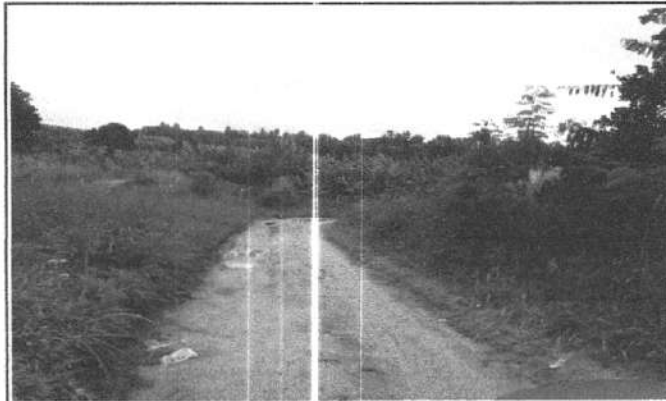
Trecho: Rua S.D.O. 02 - Vila Santo Expedito
